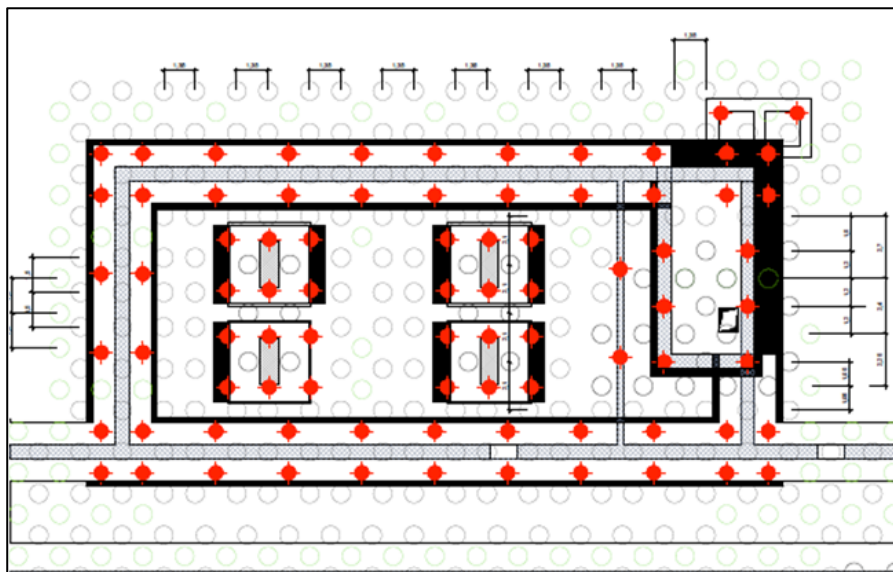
C.le di Porto Corsini - Planimetria della palificata.
